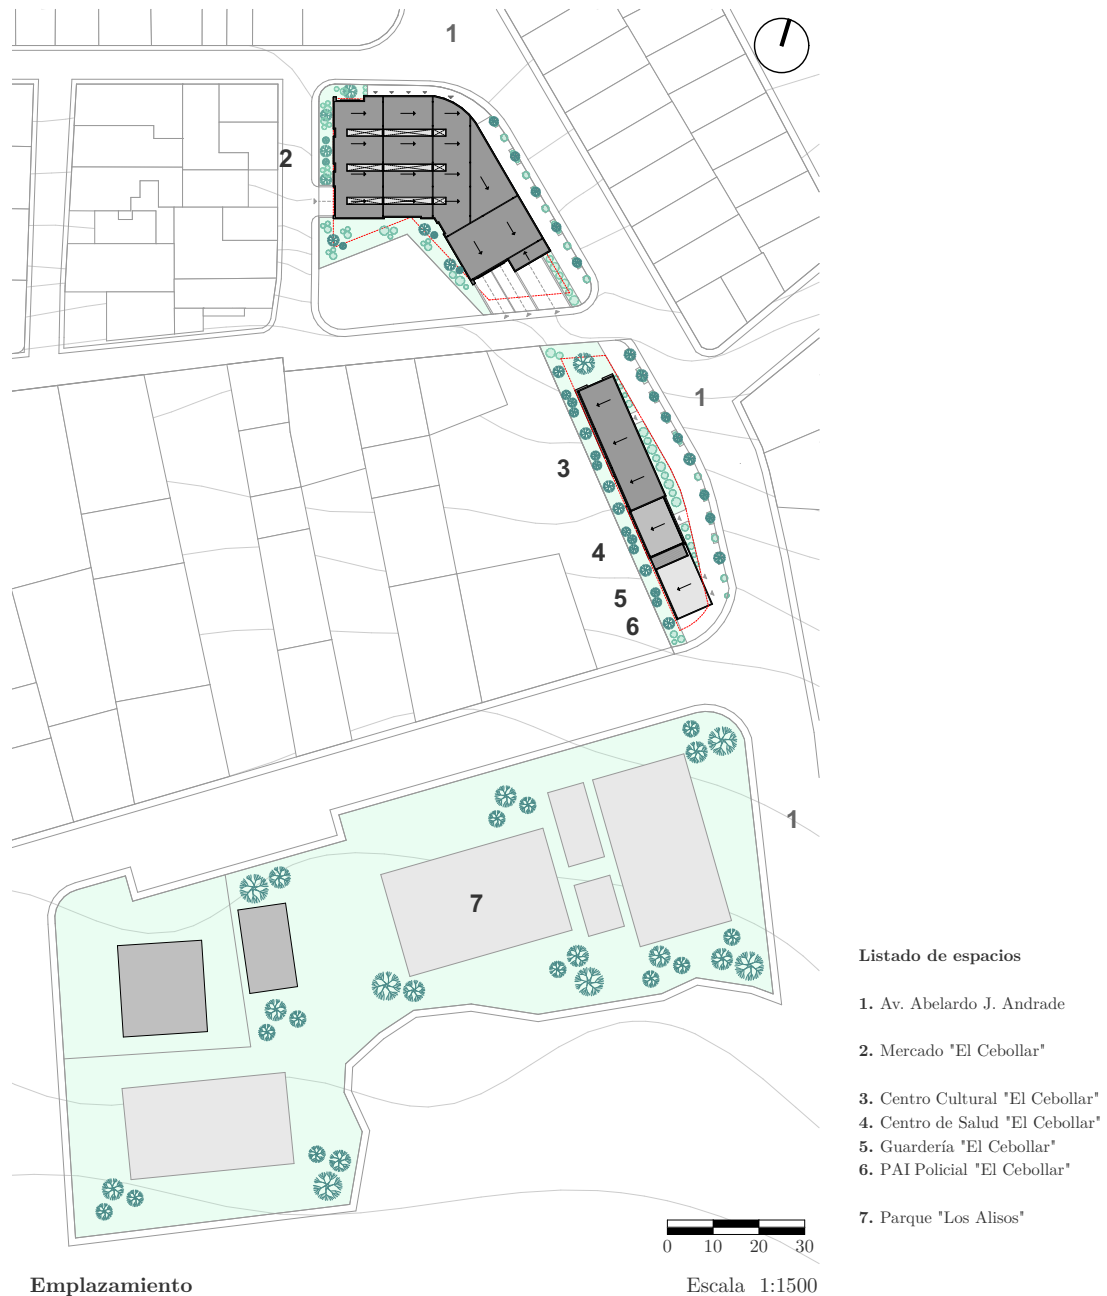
Emplazamiento. Elaborado: Autores.
